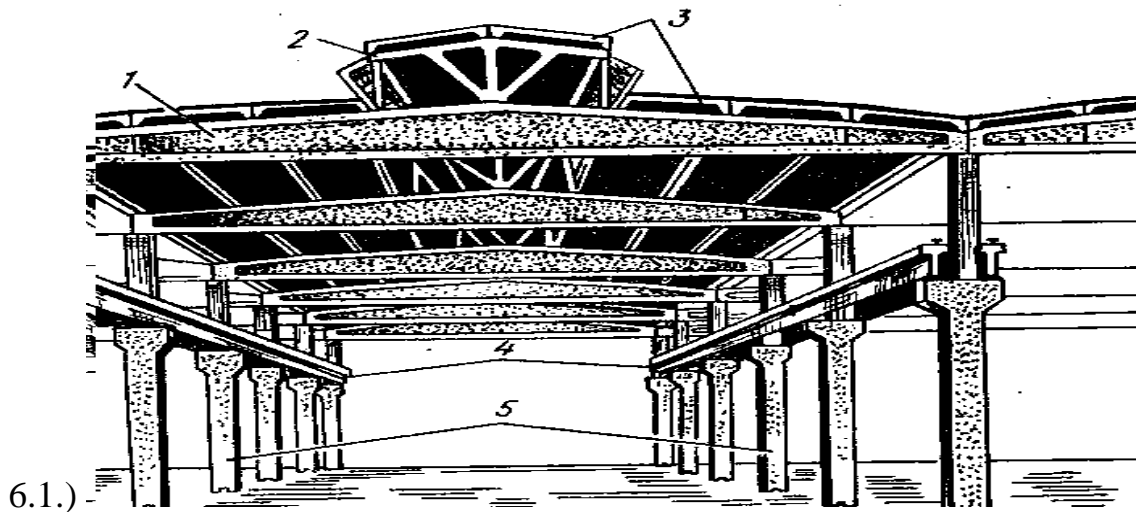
Железобетонная конструкция в промышленном здании. 1-балка, 2-фонарь, 3-плиты покрытия, 4-подкрановые конструкции, 5-стойки.
